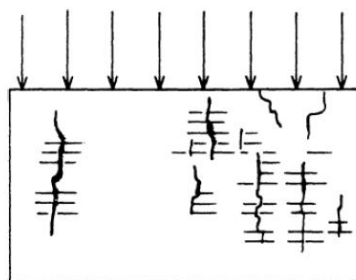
Fissuração em alvenaria devido a sobrecarga excessiva [1].
